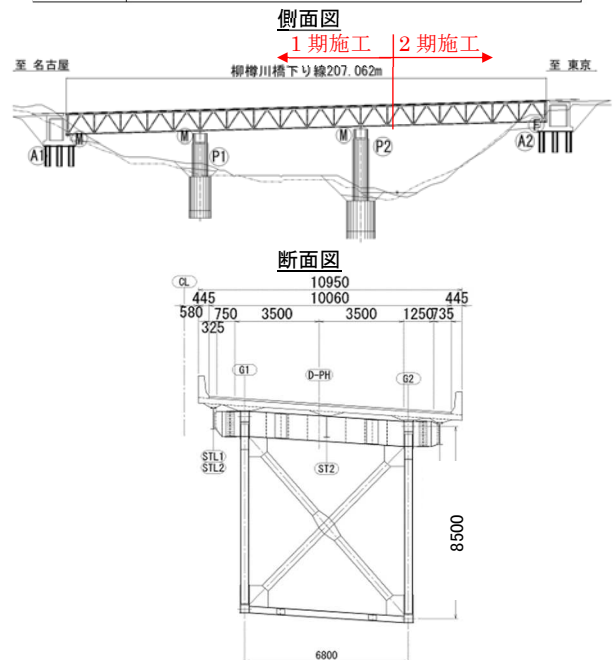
柳樽川橋(下り線)橋梁一般図(側面・断面図)
